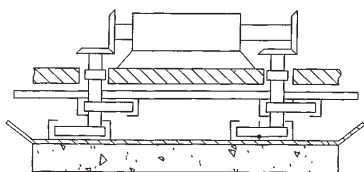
Рабочий орган в виде бруса, совершающего круговое движение
